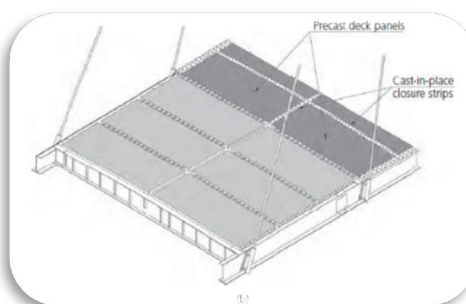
Esquema típico de tablero con panel de concreto prefabricado. Fuente:
